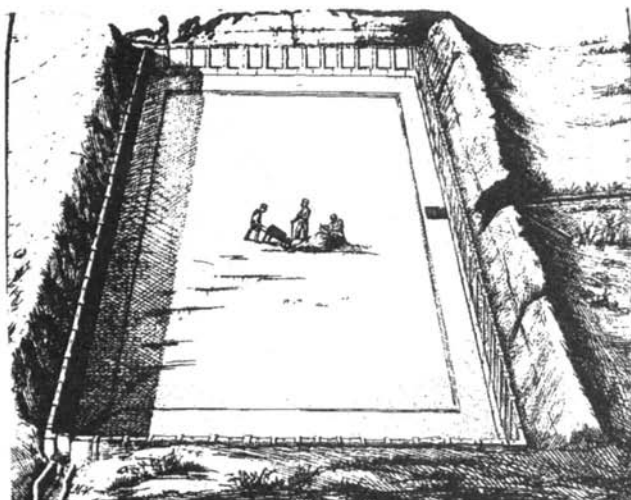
Bassin de Kasrou, vue d'ensemble par Moliner-Violle.
